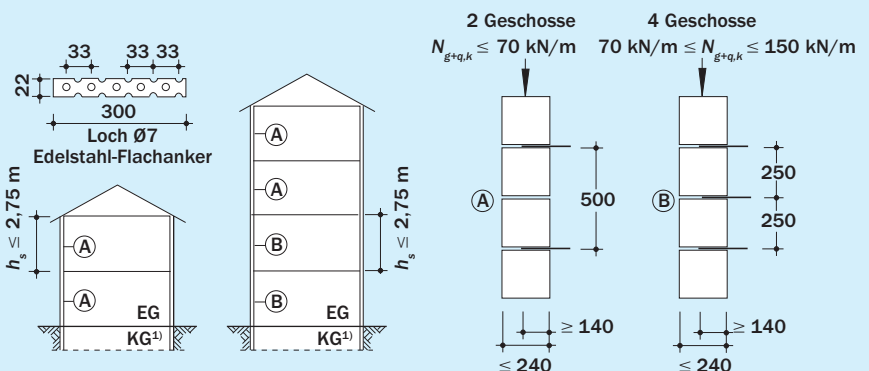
KS-Stumpfstoßtechnik, Regelausführung bei Annahme einer drei- oder vierseitigen Halterung der tragenden Wand (Schichthöhe ≤ 25 cm)
